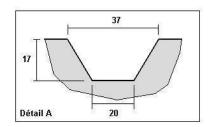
Panneaux à bossage Type 1 (dimensions en mm)
